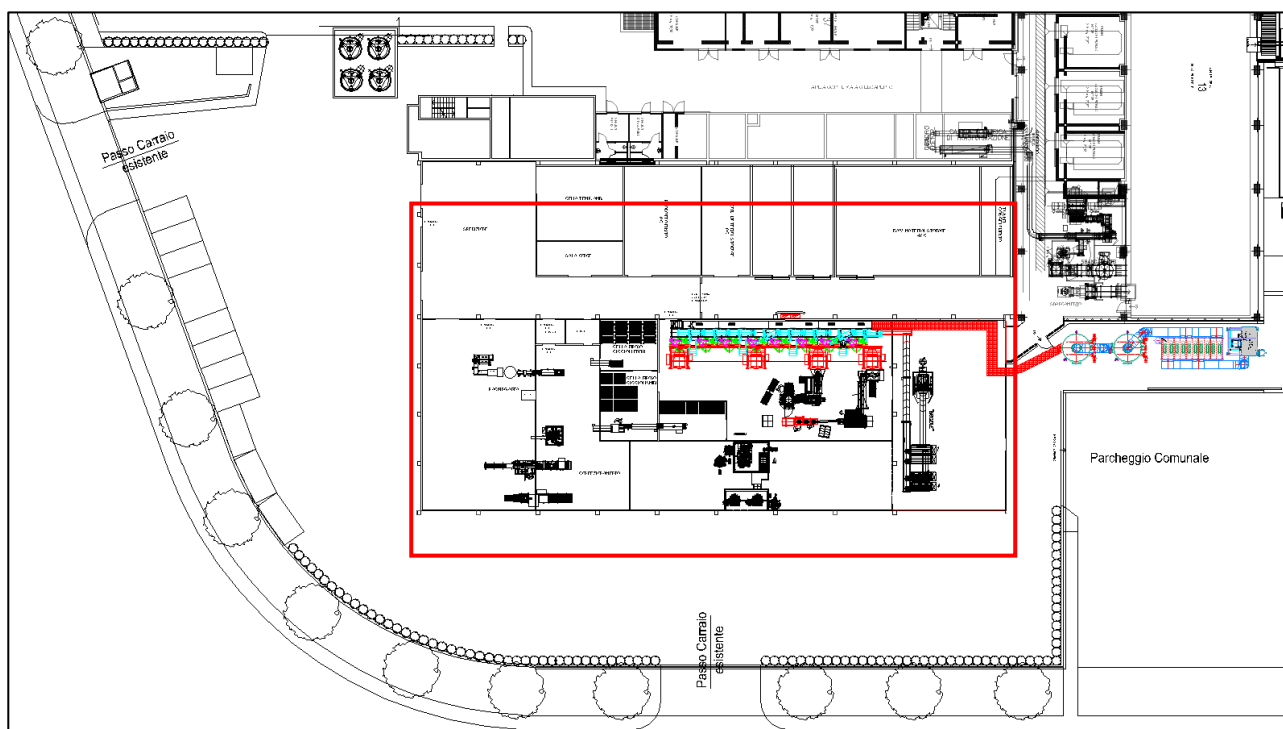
Planimetria dell'impianto di Castelnuovo Rangone. In rosso viene evidenziata la parte futura dell'impianto adibita alla produzione di ciccioli e strutto.
